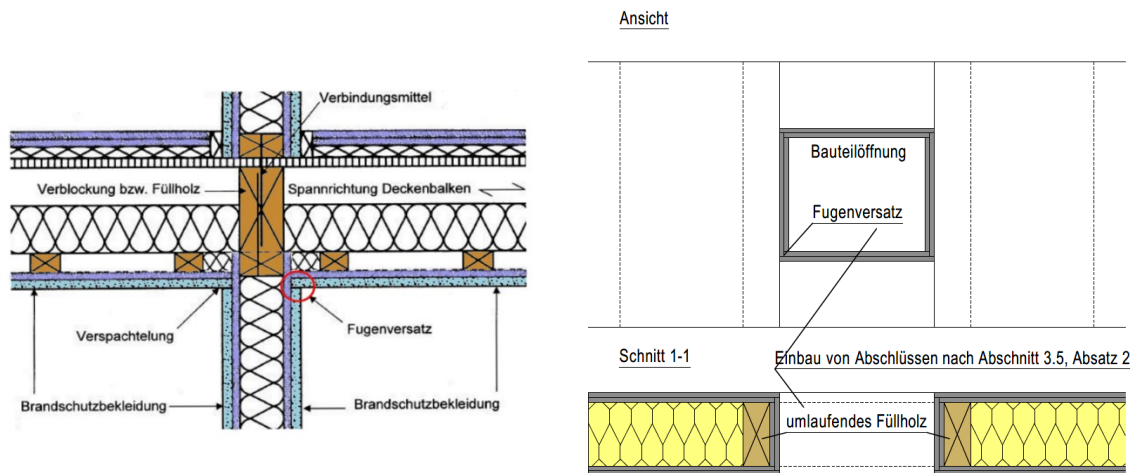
(links): Prinzipskizze 2: Anschluss Wand an Decke (MHolzBauRL)
